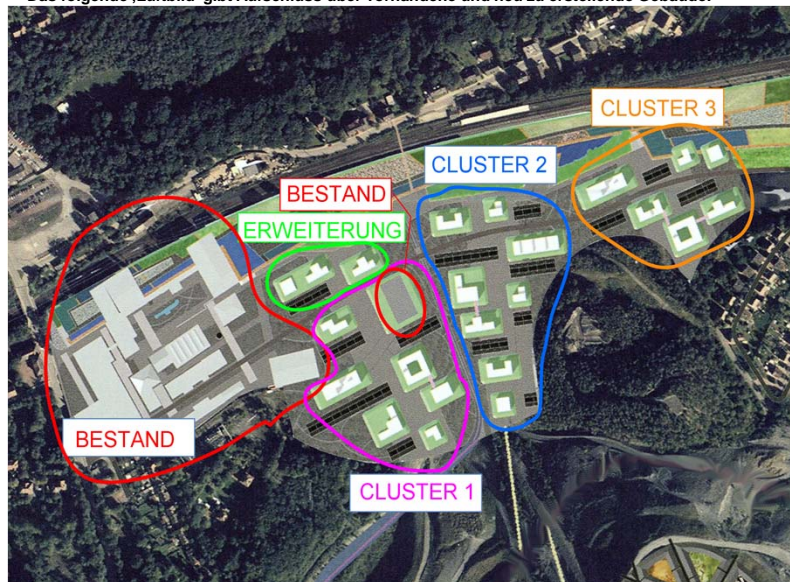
Lageplan des in der Entwicklung befindlichen Gewerbegebiets mit Bestandsgebäuden (Bestand) und vorgesehenen Erweiterungsbereichen (Cluster 1, 2 und 3)
